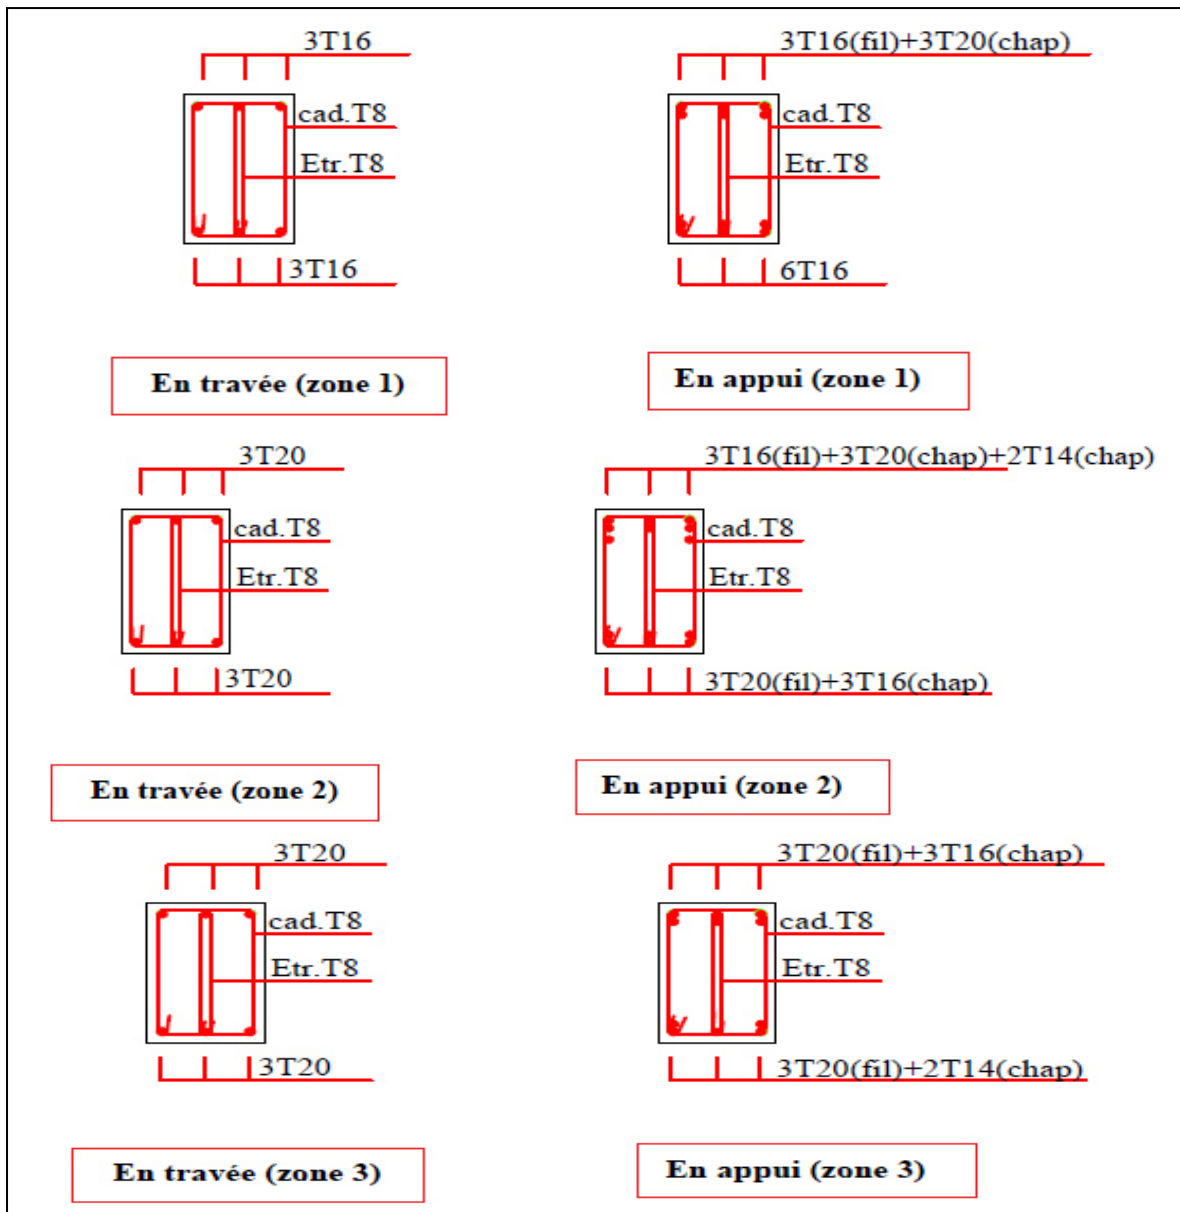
Schéma de ferrailage de la poutre secondaire liée au voile
